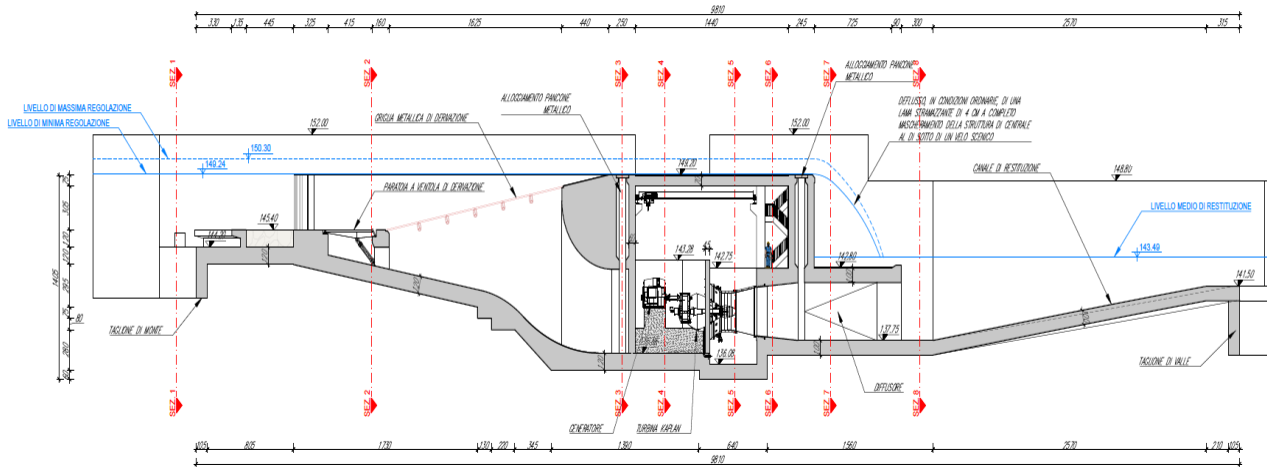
Profilo di progetto dell'impianto idroelettrico.
